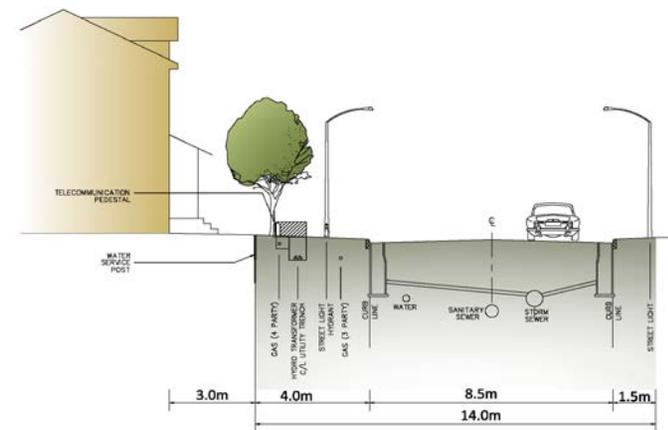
Section transversale d'une route bordée de constructions d'un seul côté (14,0 m)
